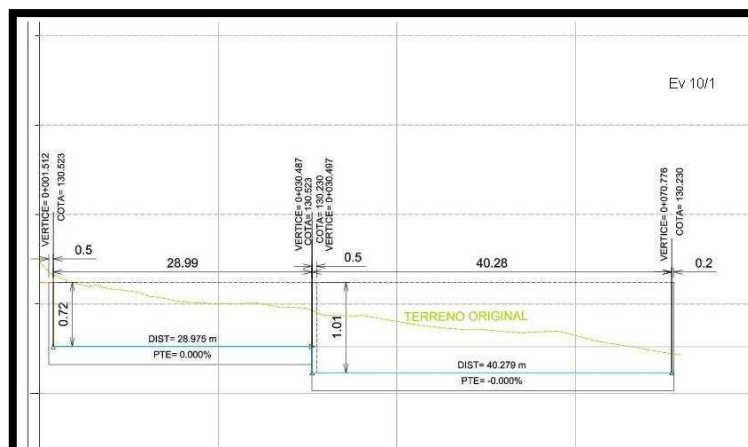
Detalle longitudinal balsa lateral muro.
